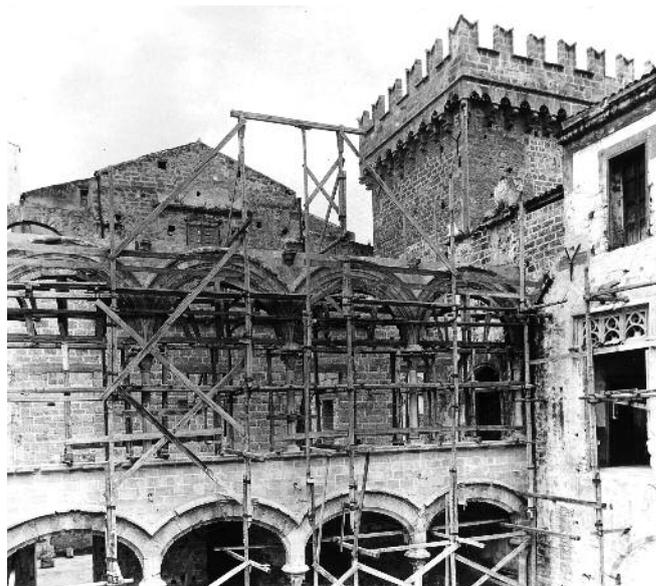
Palermo. Palazzo Abatellis, il cantiere di rimontaggio e ricostruzione del loggiato, in questa fase l'intervento sulla torre è stato già completato (MBACT, ICCD - Archivio MPI, fondo P).
